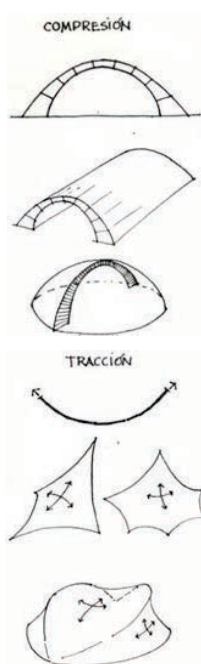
Diagramas de las tensiones aplicadas en la arquitectura textil.
